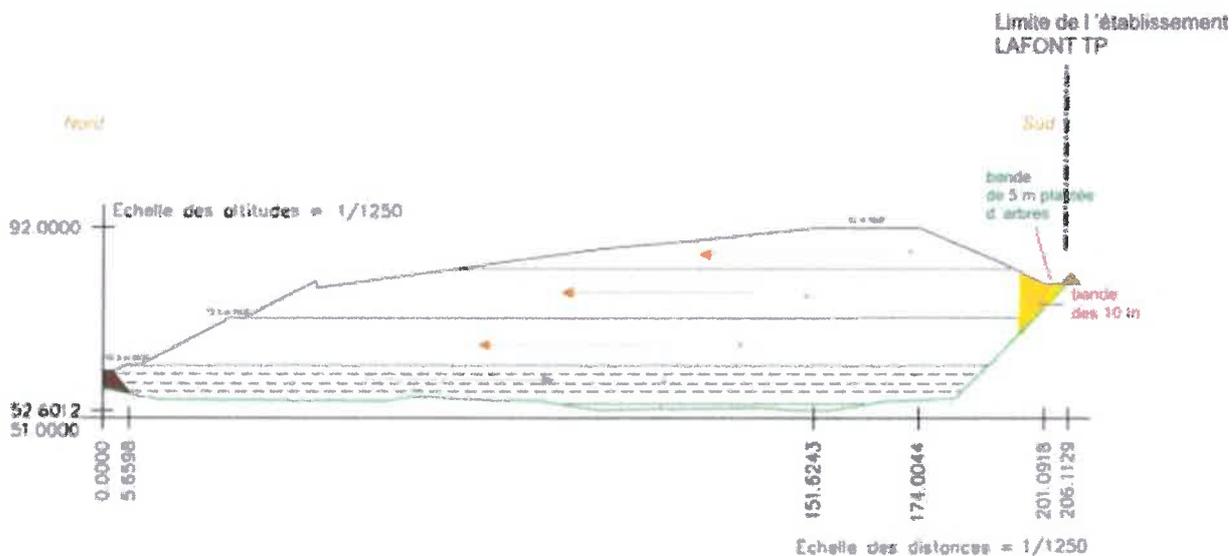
schéma de principe du remblaiement (coupe A-A, extrait DDAE A.LAFONT TP)
